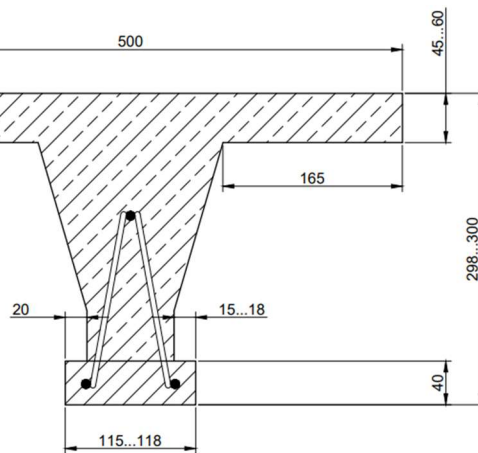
Поперечное сечение испытанного фрагмента перекрытия «ДАХ-2»
